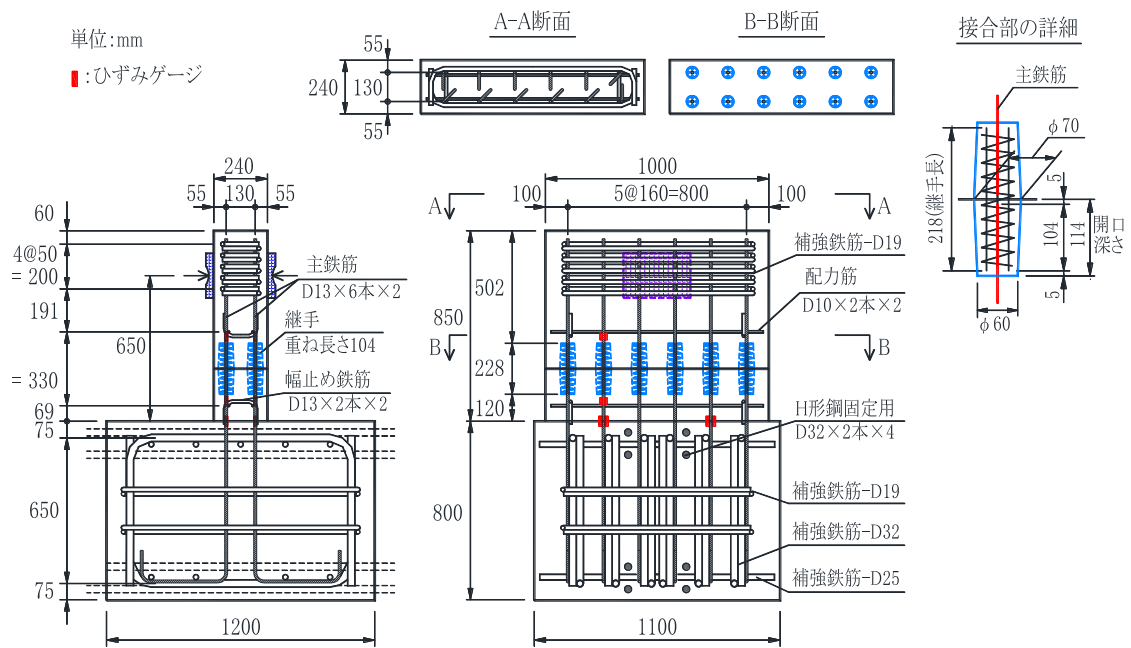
試験体の形状寸法と配筋 (JD13A, JD13B)
